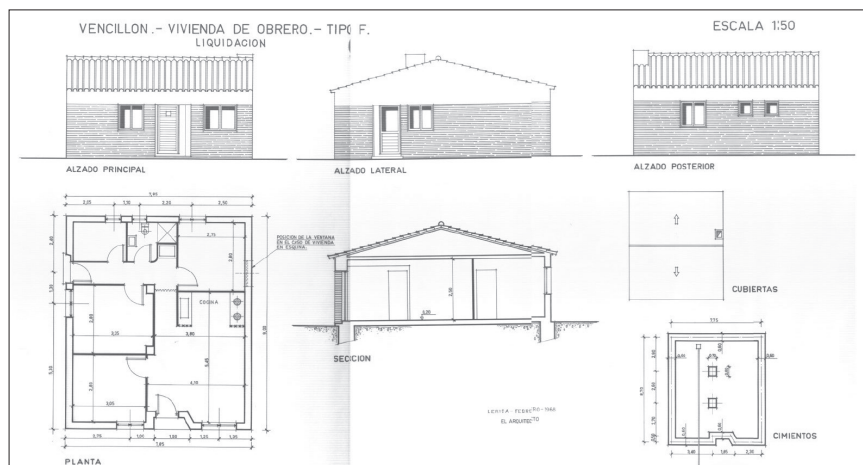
Tipologías de vivienda: casa de obrero tipo F.
